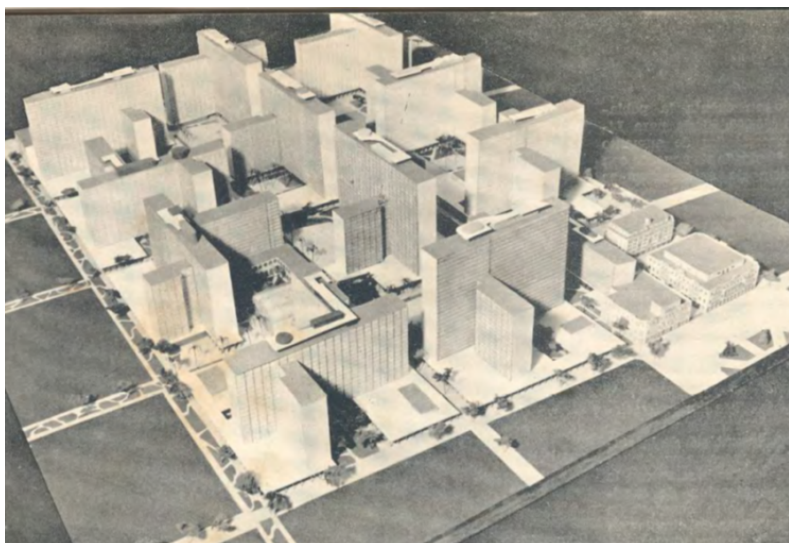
Propuesta de edificación para el sector central. Plan Piloto de Lima, 1949.
